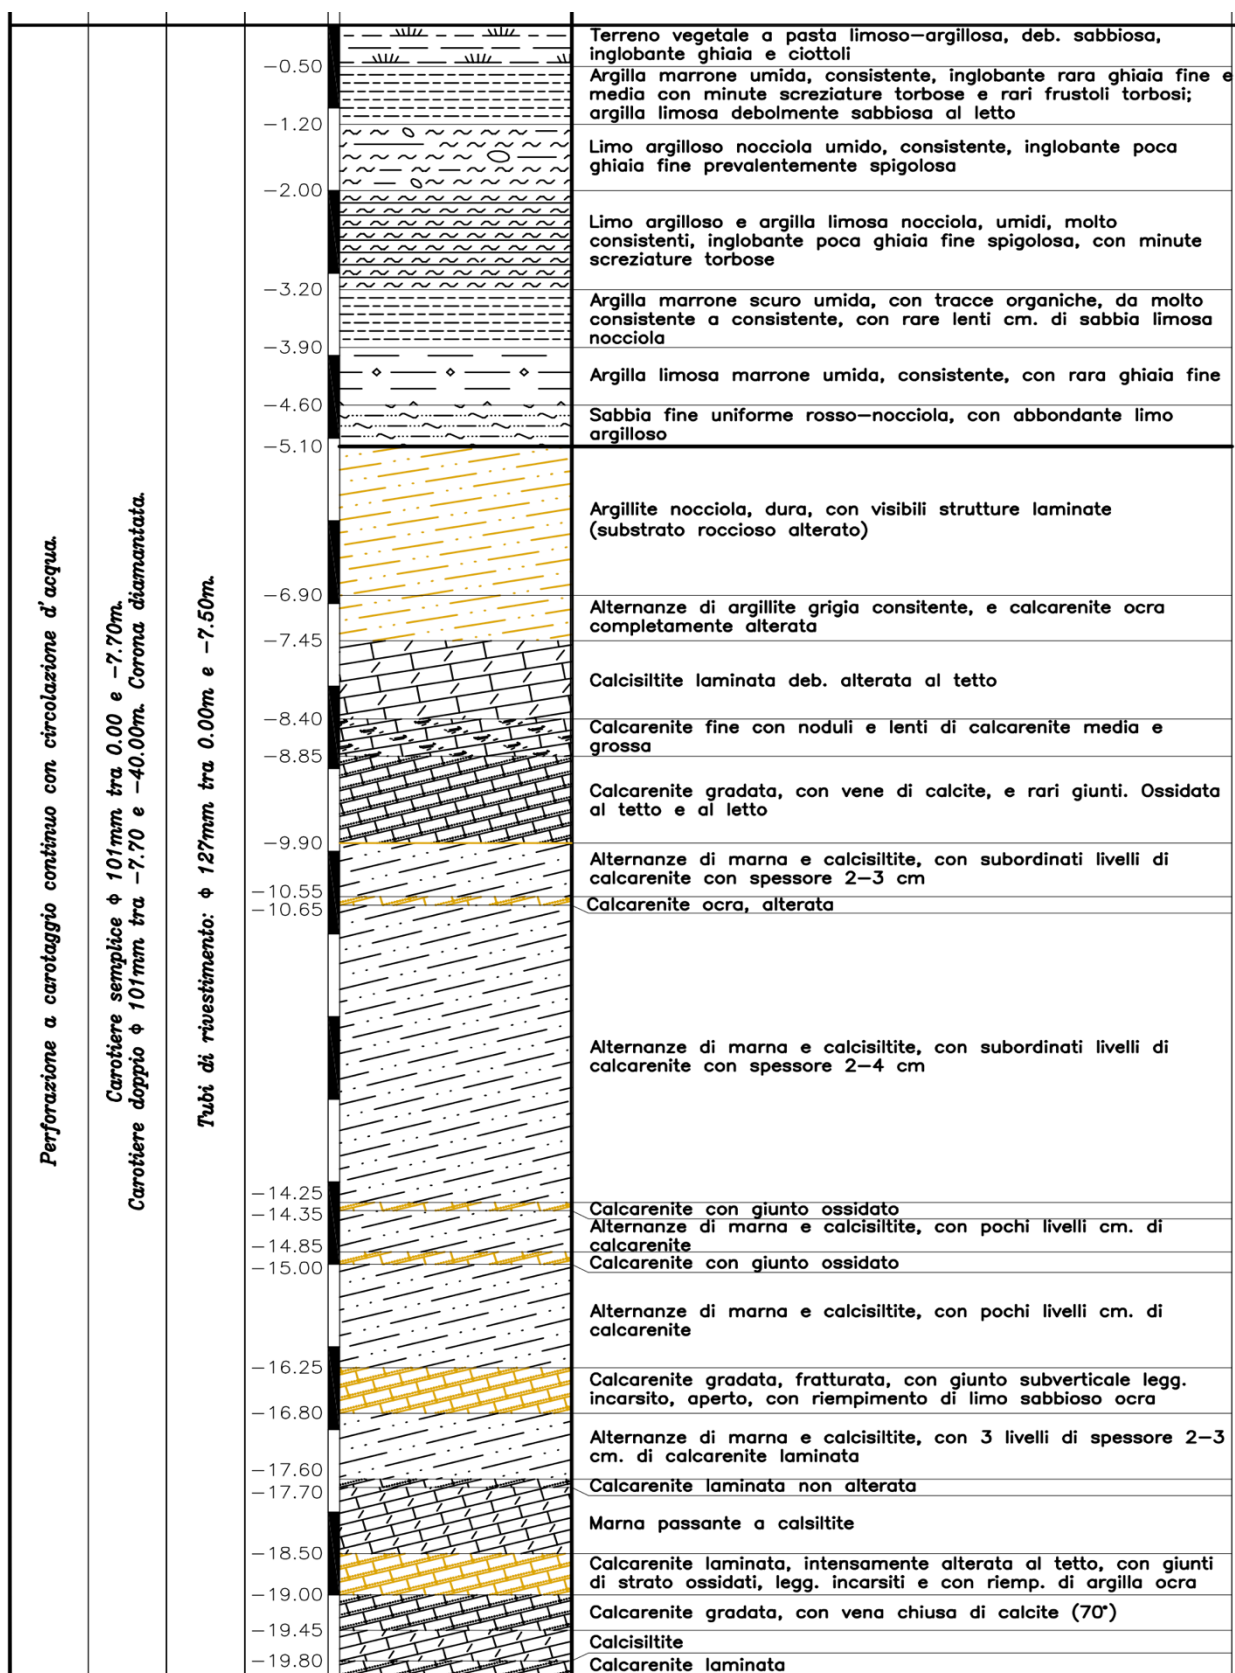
Sezione stratigrafica sondaggio S6 2008 - Veneto Strade Spa
